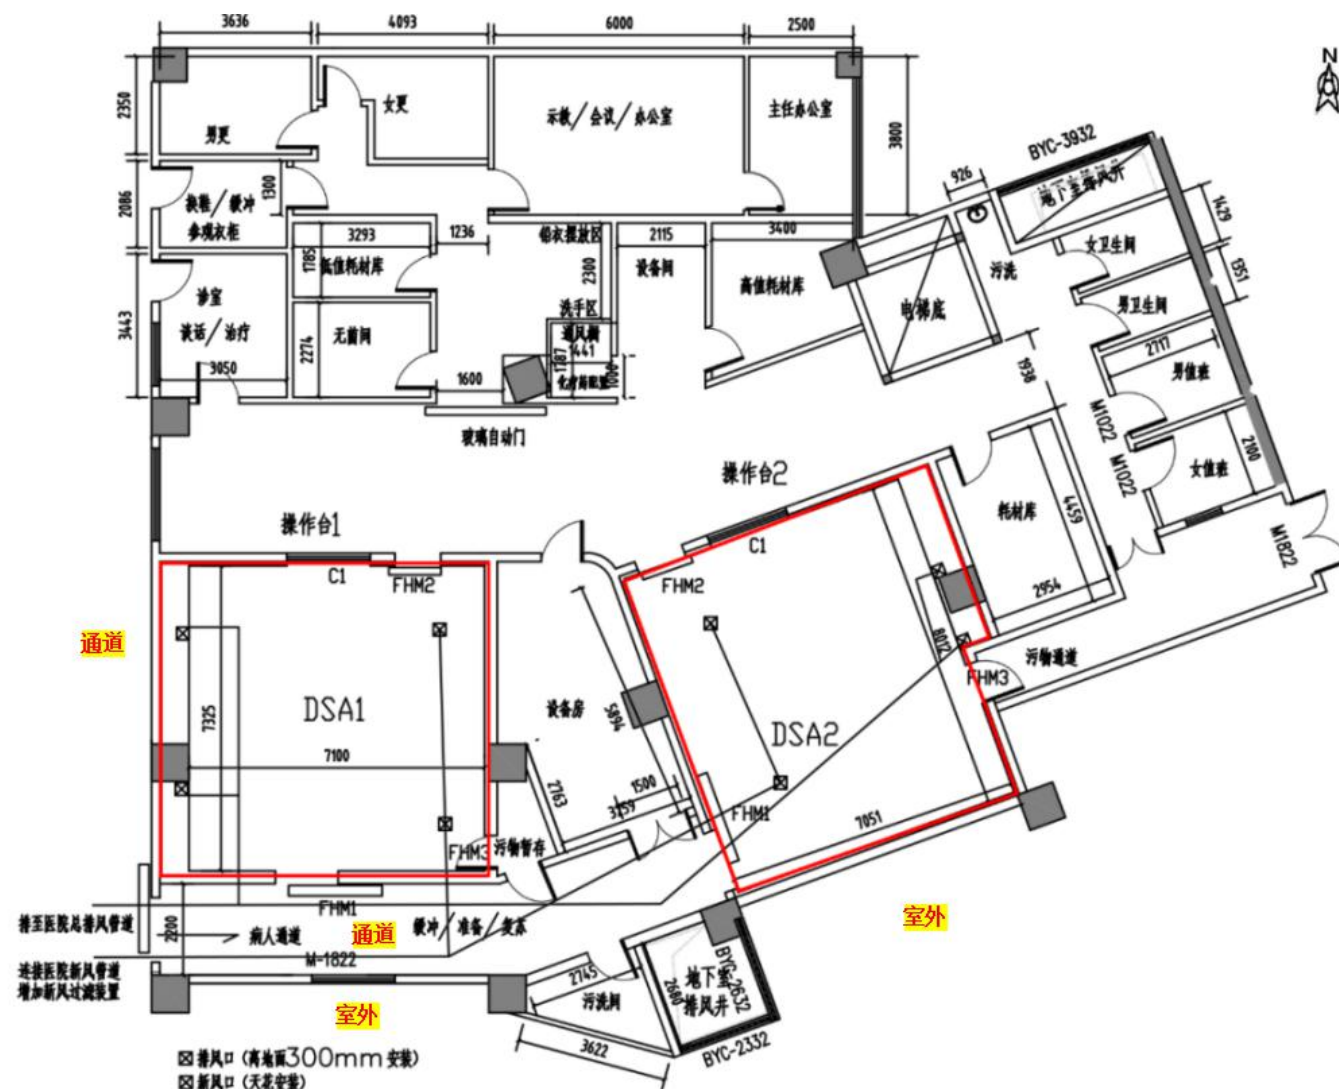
项目建成后 DSA 机房平面布局图及四至图
